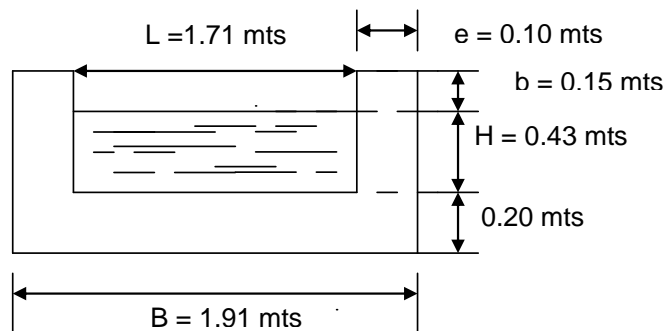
Sección de Vertedero de concreto con contracciones laterales
